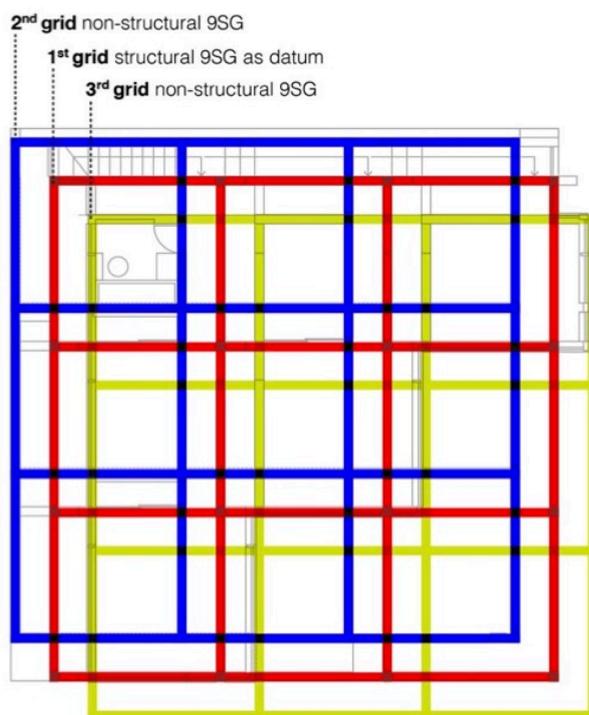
Planta-baixa do primeiro pavimento da *House II* com o terceiro *grid* (em amarelo) delimitado por Karaman. Fonte: KARAMAN, 2012, p.41.
